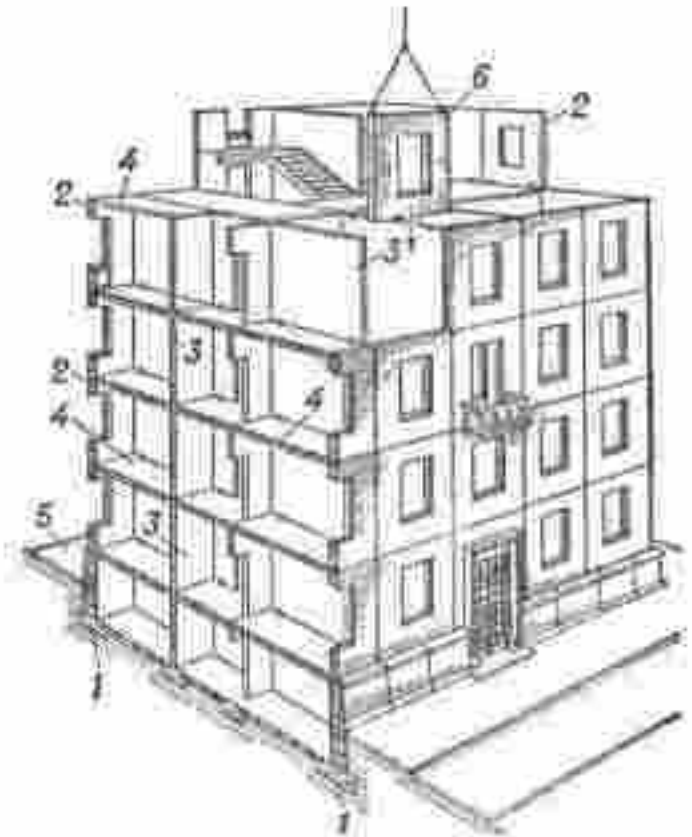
Крупнопанельные конструкции многоэтажного жилого дома: 1 — фундаментная плита; 2 — наружная стеновая панель; 3 — внутренняя стеновая панель; 4 — панель междуэтажного перекрытия; 5 — отмостка; 6 — наружная панель в процессе монтажа.
